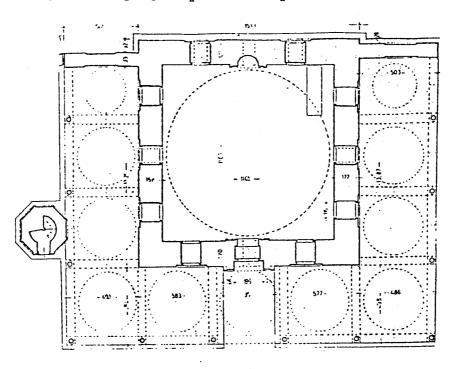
مسقط أفقي لمسجد الشيخ لطف الله (الطابق الثاني) (عن : كنجنامه) .
